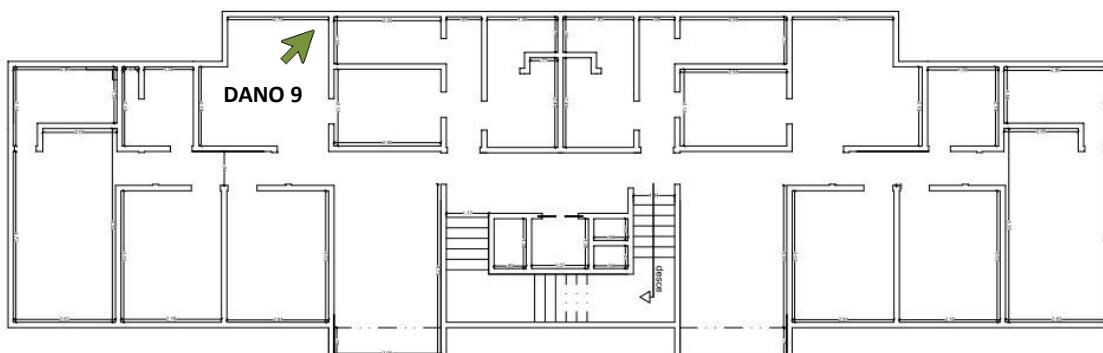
Planta Baixa (croqui) – Pavimento do 1º andar – Bloco B – Cond. Armando Lôbo.
